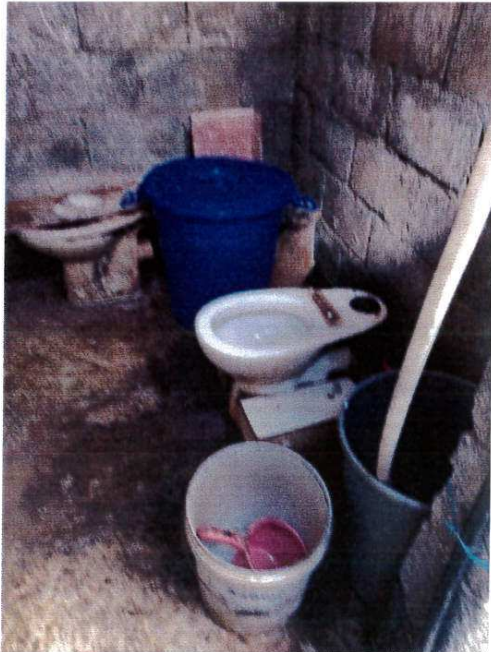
équipement sanitaire rudimentaire, absence d'installation d'assainissement.
